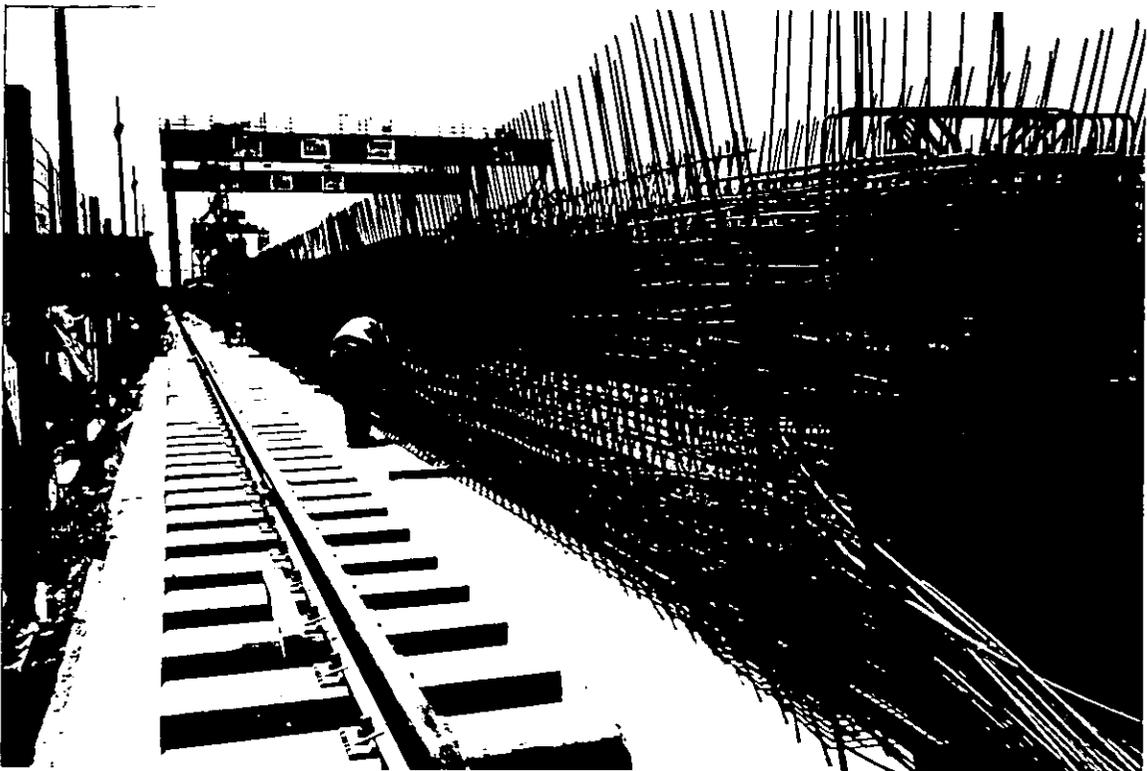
Inserción del acero de presfuerzo en el armado del acero de refuerzo de trabe central (TC) con peralte de 2.00 m
